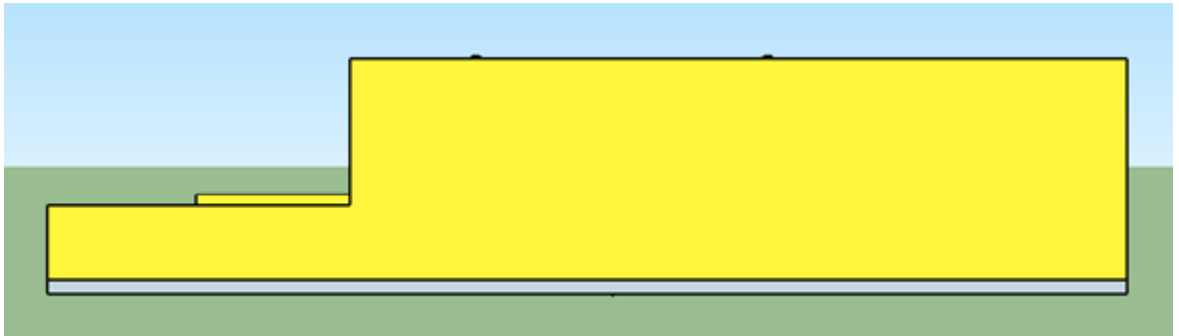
Tipe 38 Tampak Perspektif Bagian Lantai
